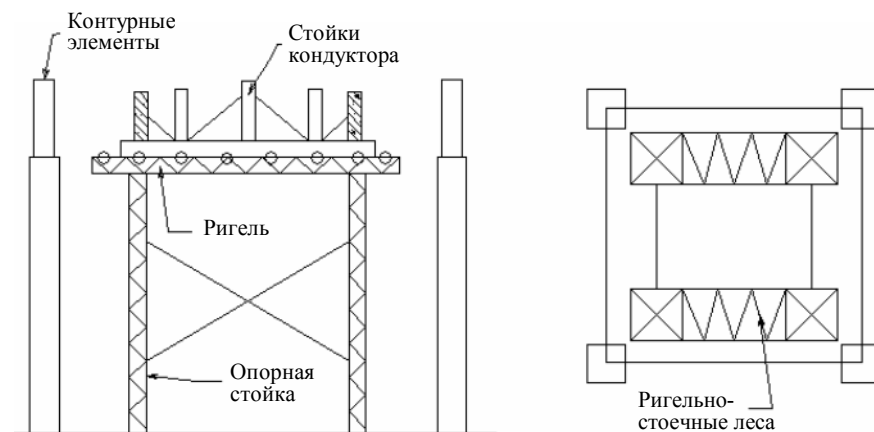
Монтаж оболочки на ригельно-стоечных лесах
